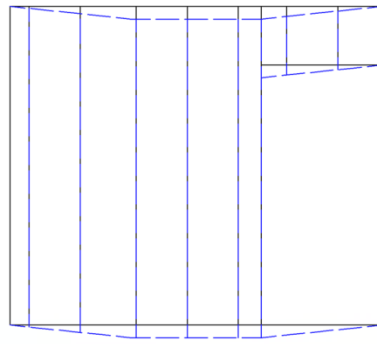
Esquema de deformaciones del muro lado sur de acuerdo con el levantamiento topográfico realizado a la estructura en su primera etapa. Se pueden observar los asentamientos diferenciales entre los extremos y la parte central del muro.
